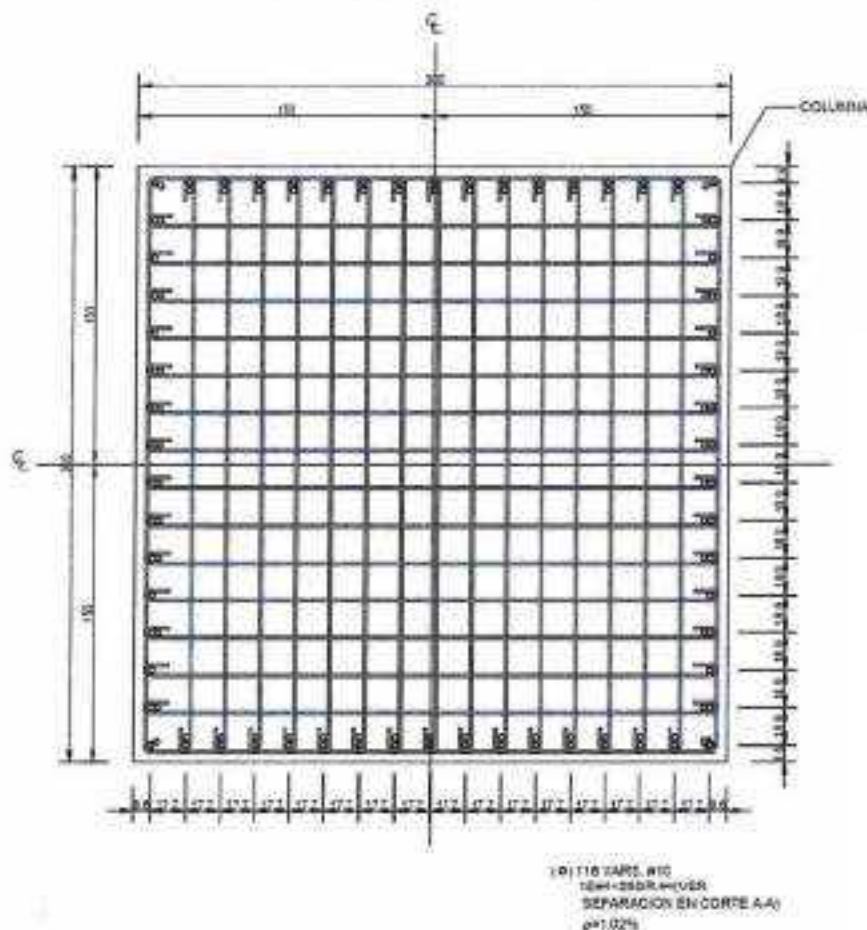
Diseño de Columnas de Concreto Reforzado
